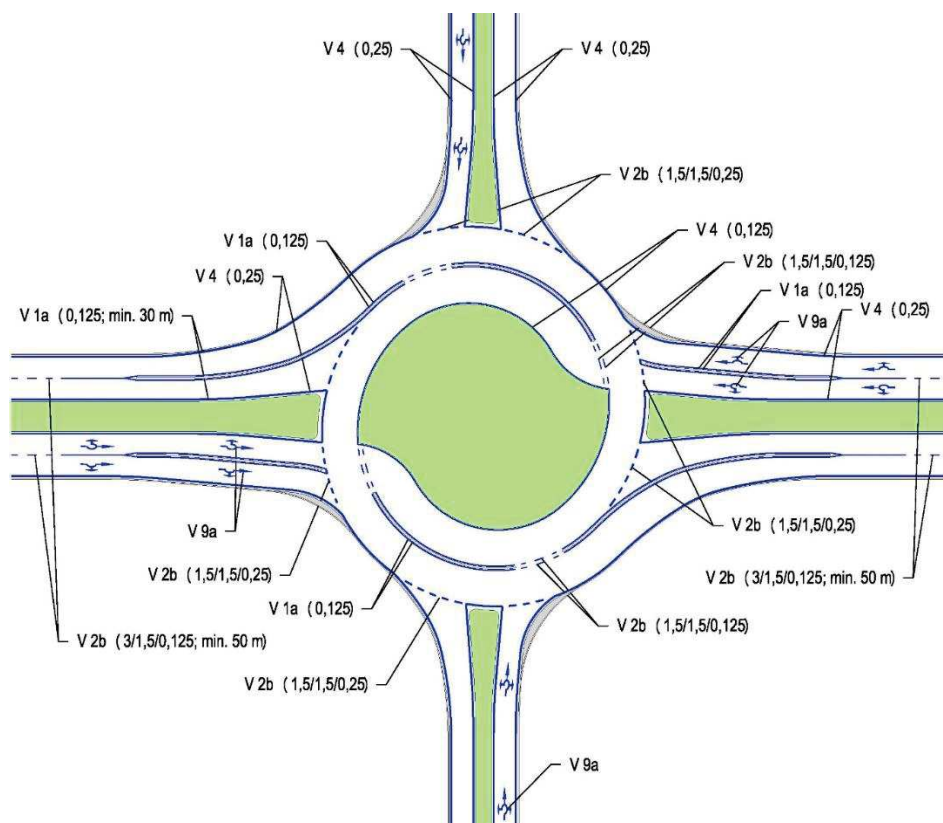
Vyznačení spojovacích větví. Převzato z technických podmínek [34].
